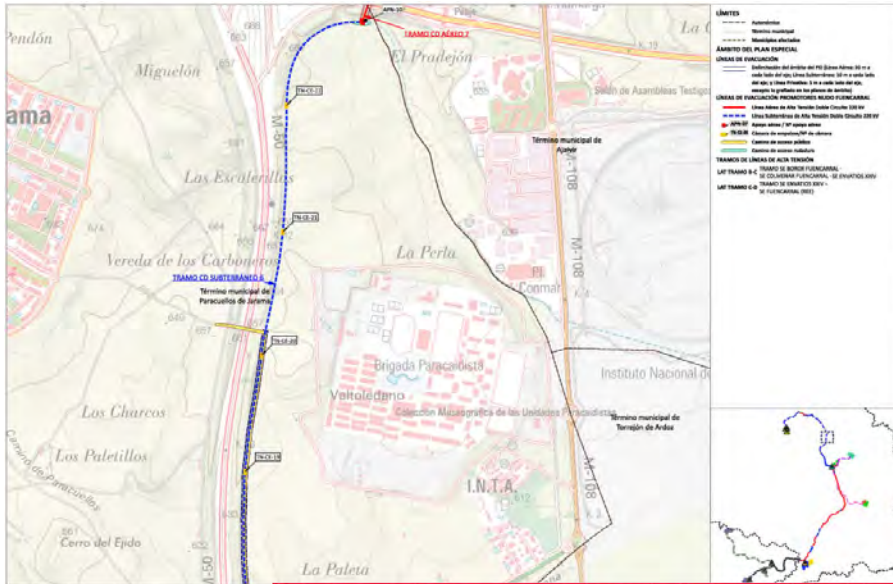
Plano de Ordenación O2.5.6. Planta por tramos. LASAT Promotores Nudo Fuencarral Tramo C-D
